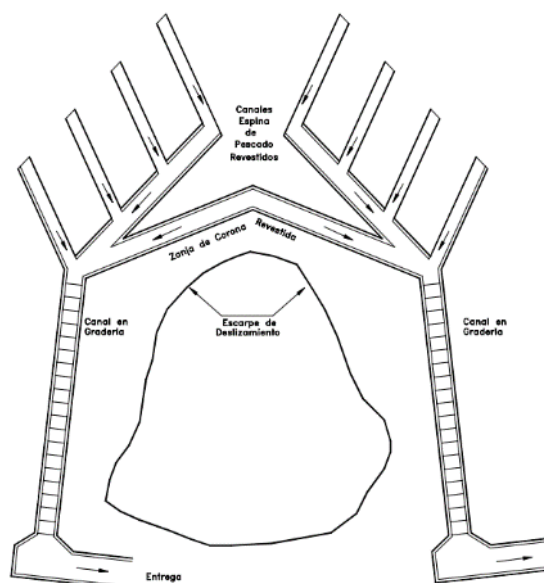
Esquema en planta de canales colectores espina de pescado. Tomado de Suárez (1998).
